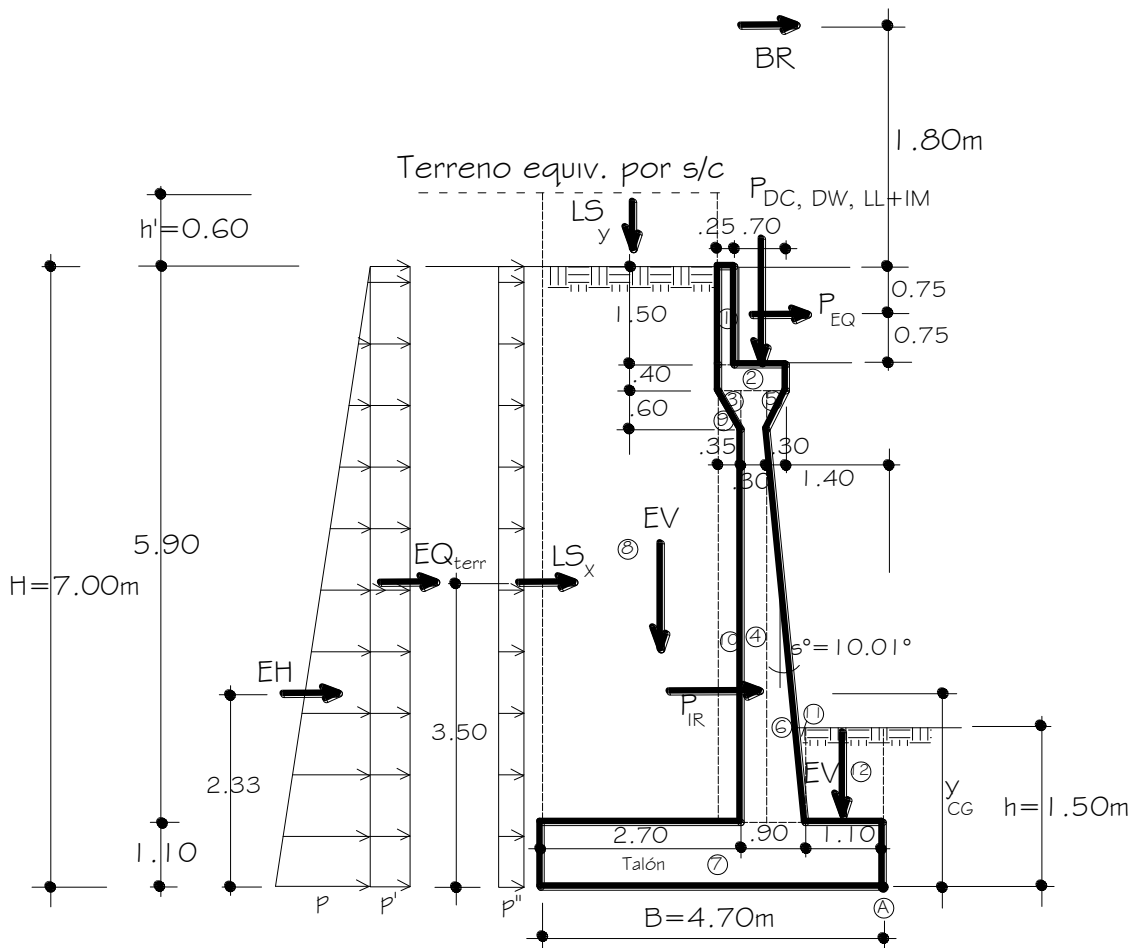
Dimensiones propuestas para el cálculo del estribo
